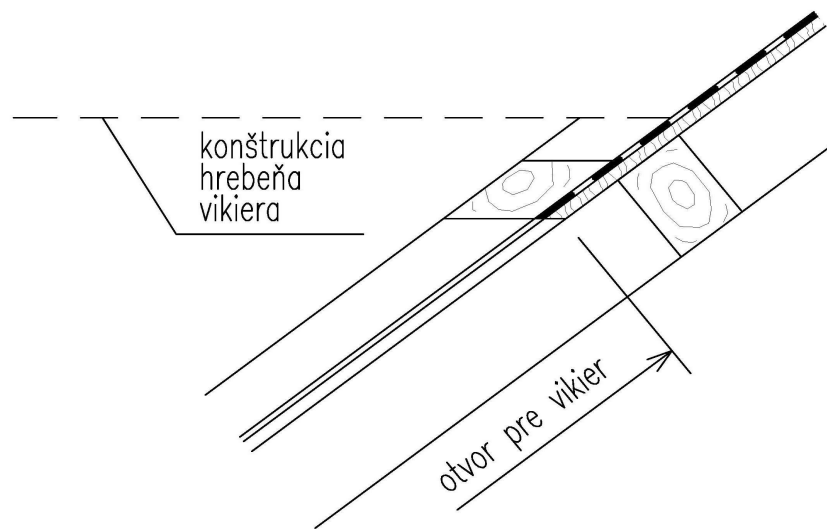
Úprava bočného okraja otvoru pre vikier
